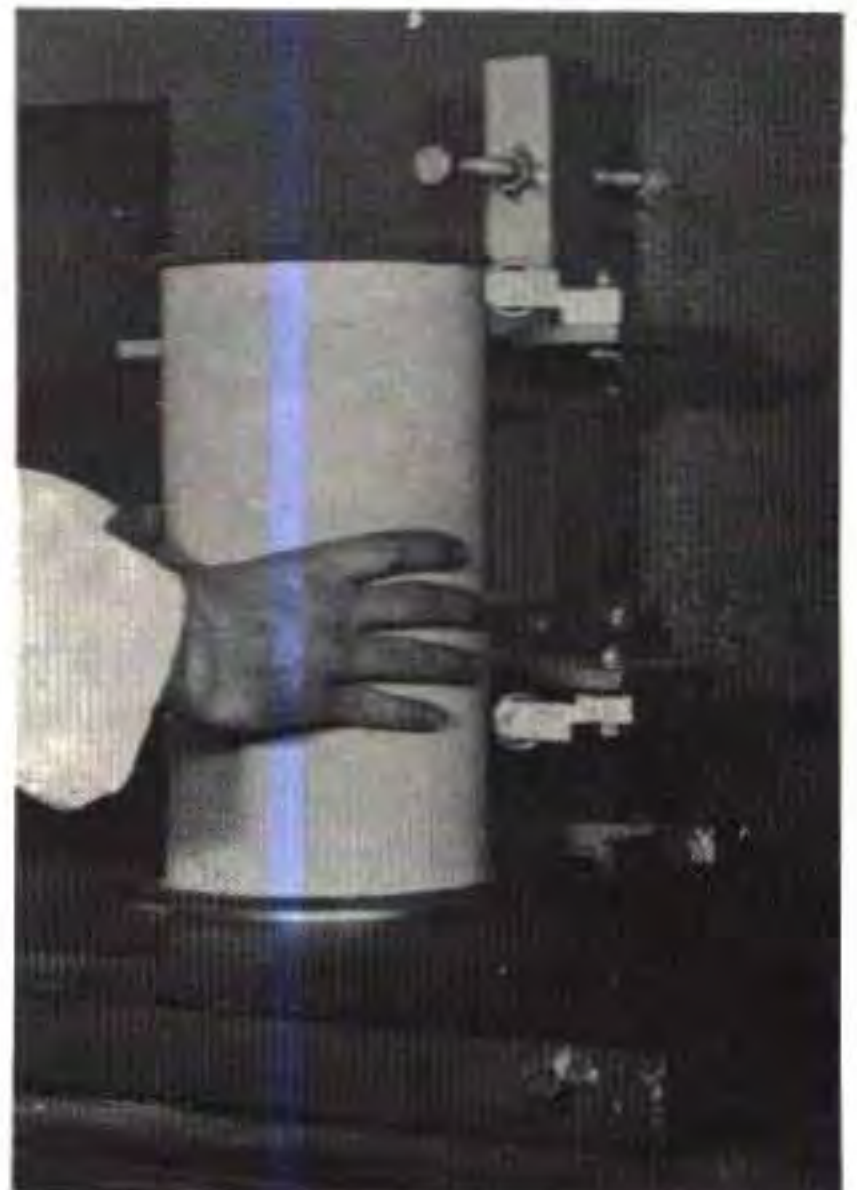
Surfaçage d'une éprouvette cylindrique au soufre.
